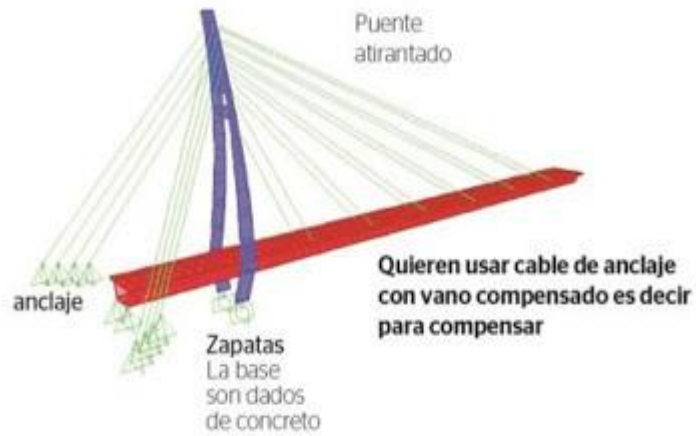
Construcción de reforzamiento en los cables atirantado opuesto.
